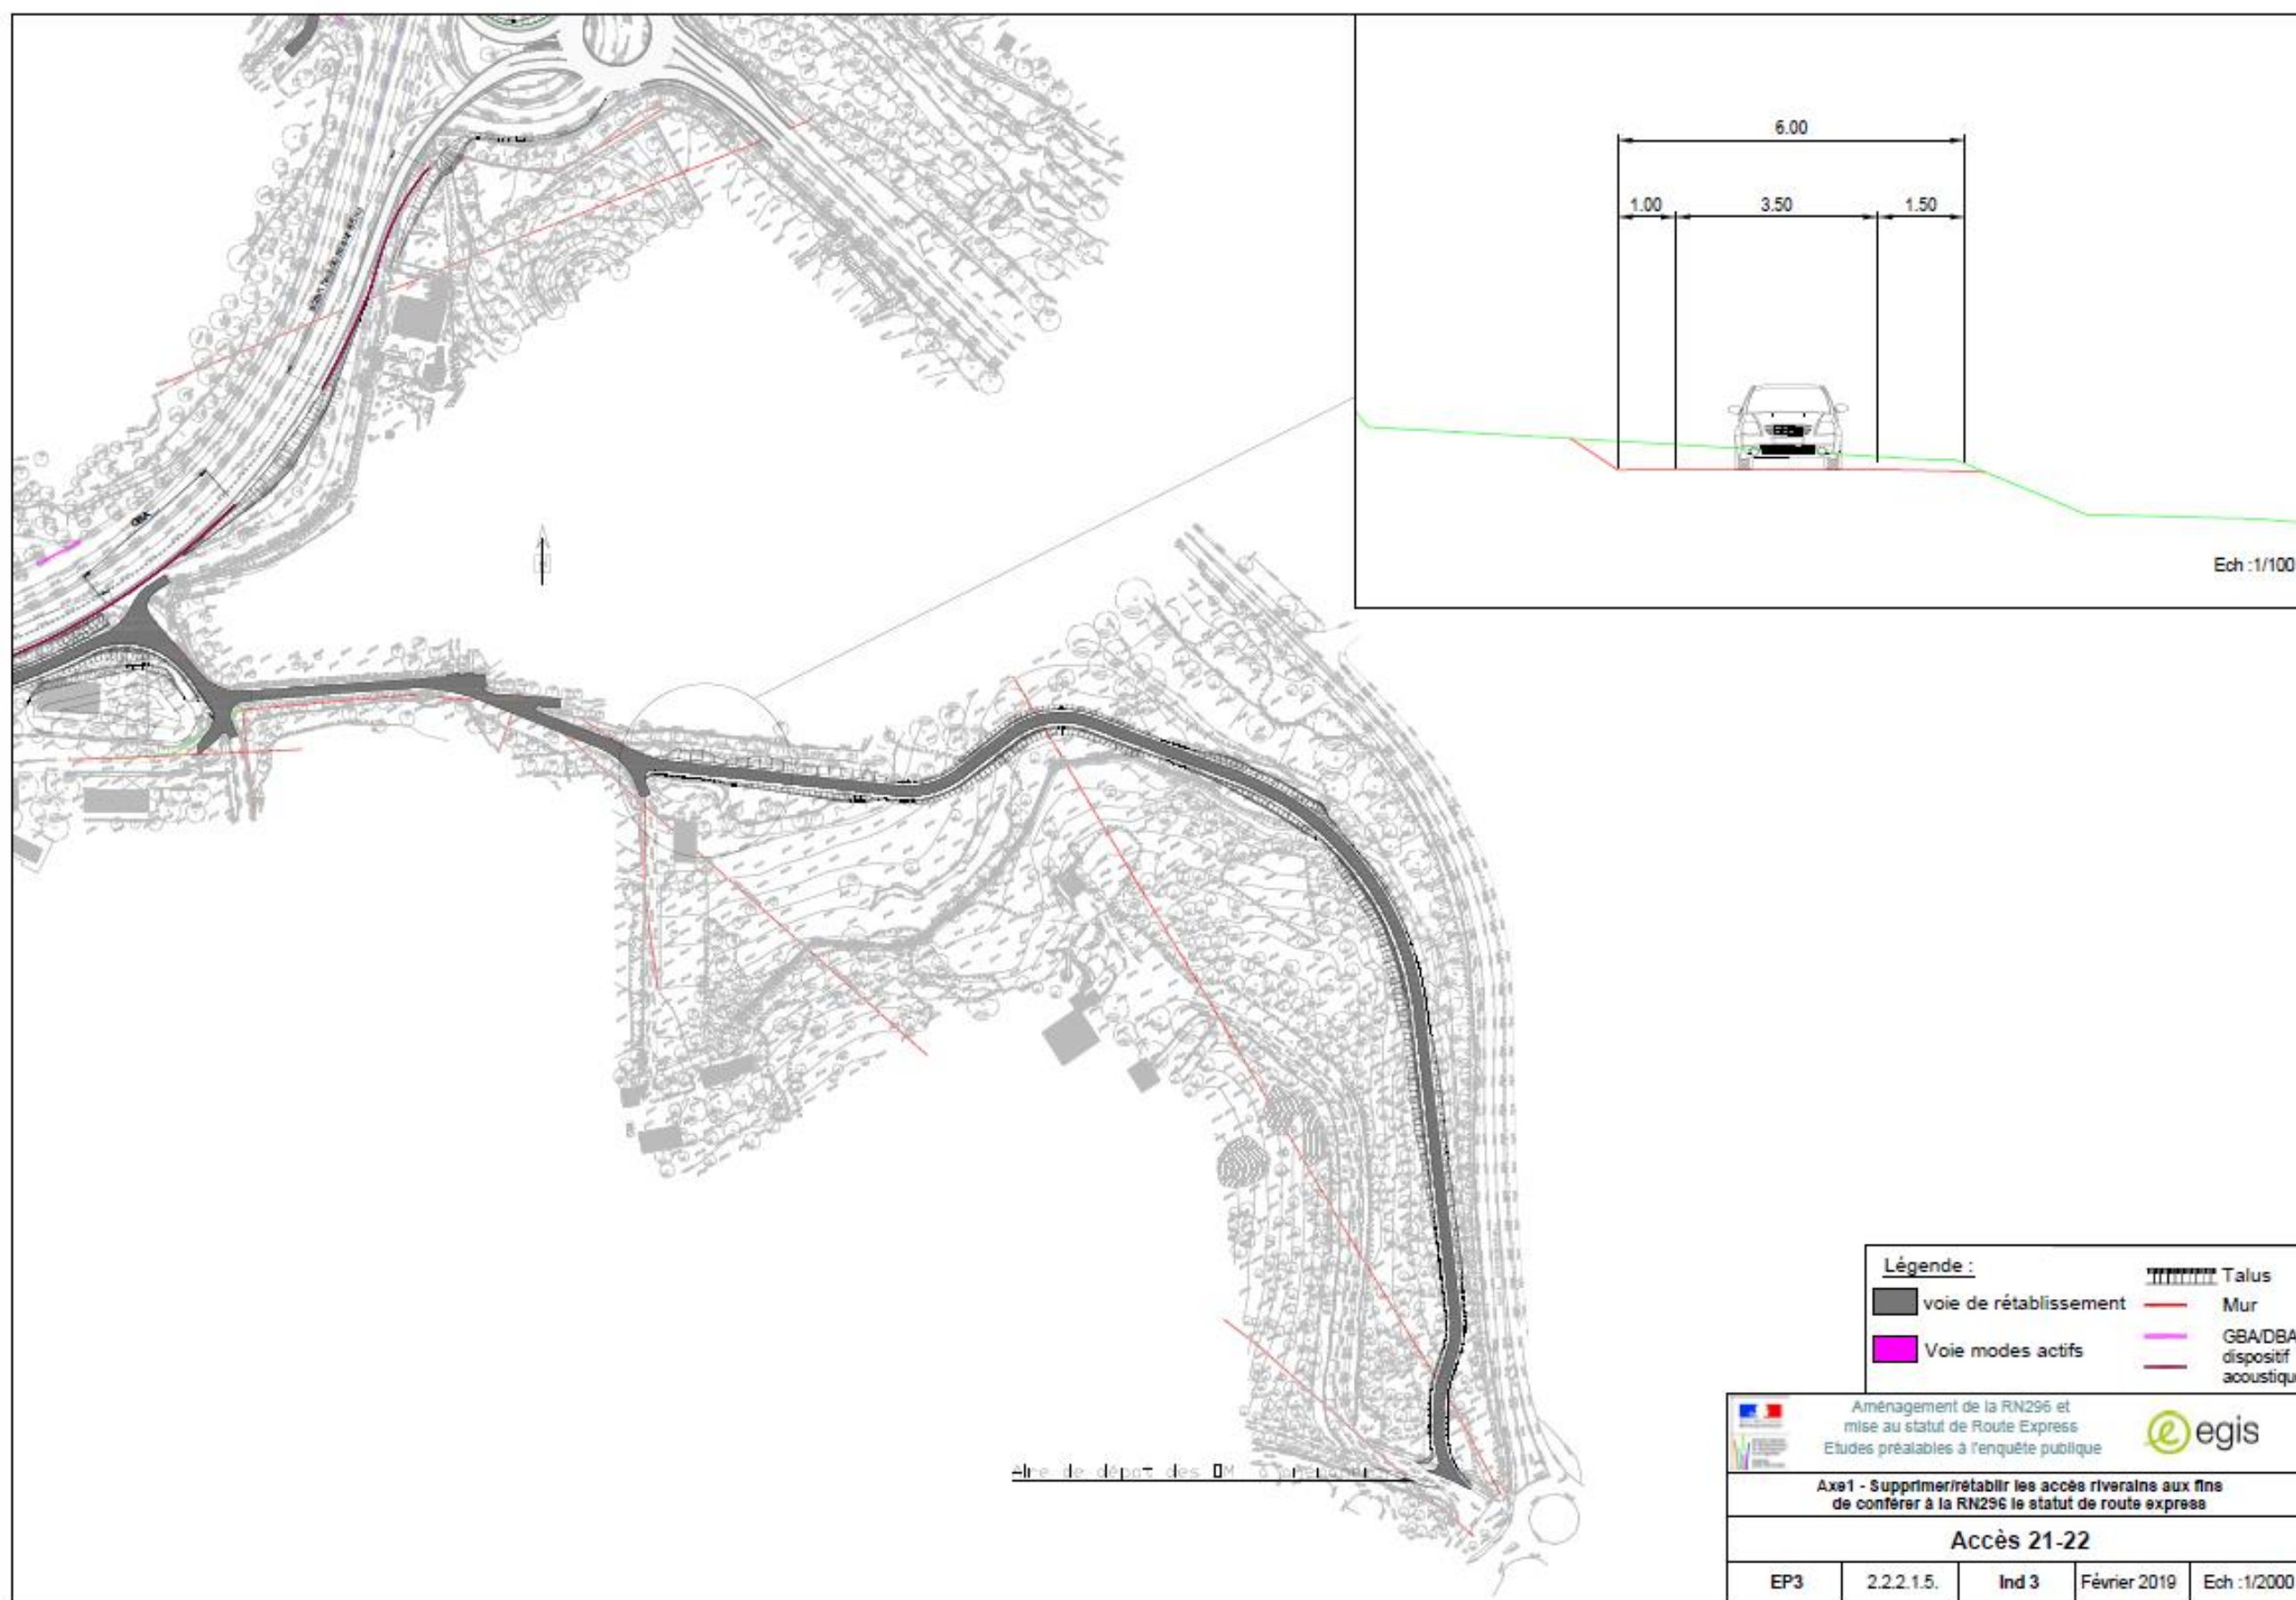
Profil en travers et vue en plan du réaménagement des accès 21 et 22
